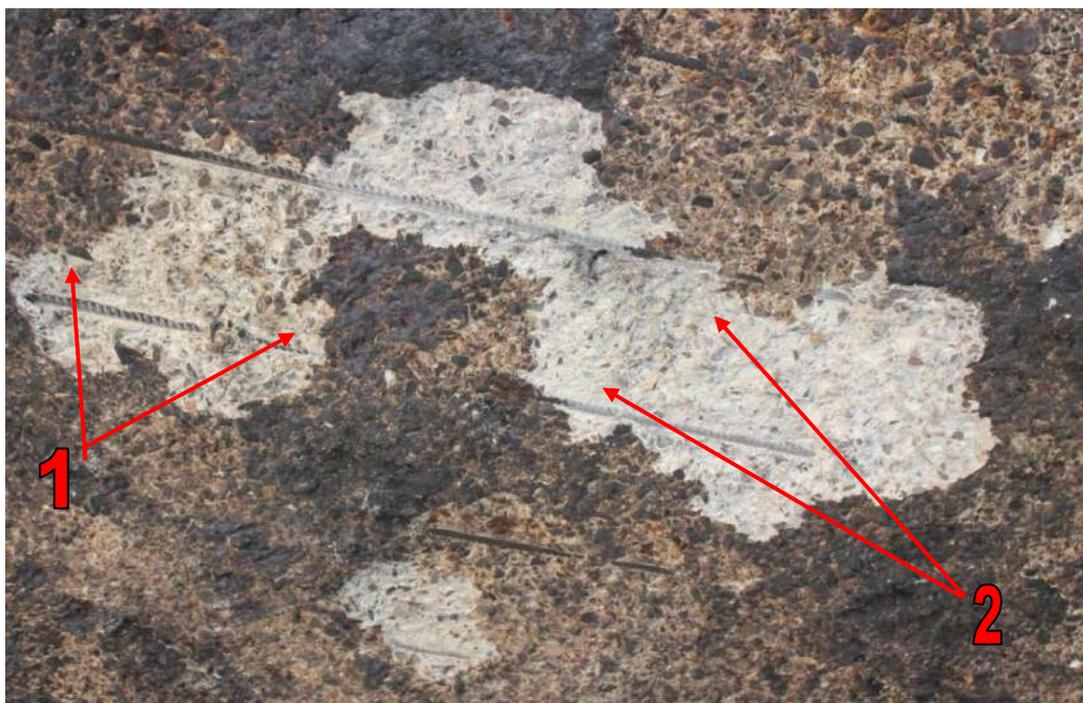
Фрагмент нижней плоскости плиты перекрытия: 1 – коррозия рабочей арматуры нижней сетки при отсутствии защитного слоя бетона проектной толщины.
